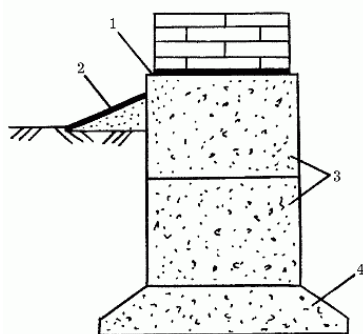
Общий вид сборного ленточного фундамента: 1 – горизонтальная гидроизоляция; 2 – отмостка; 3 – фундаментные блоки; 4 – плита фундамента
